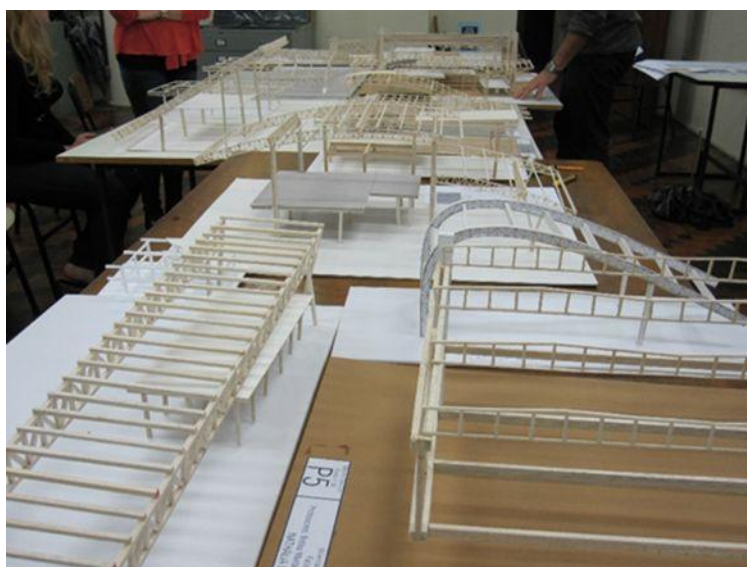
Maquetes de estudo do módulo estrutural das estações. Fonte: foto autor
